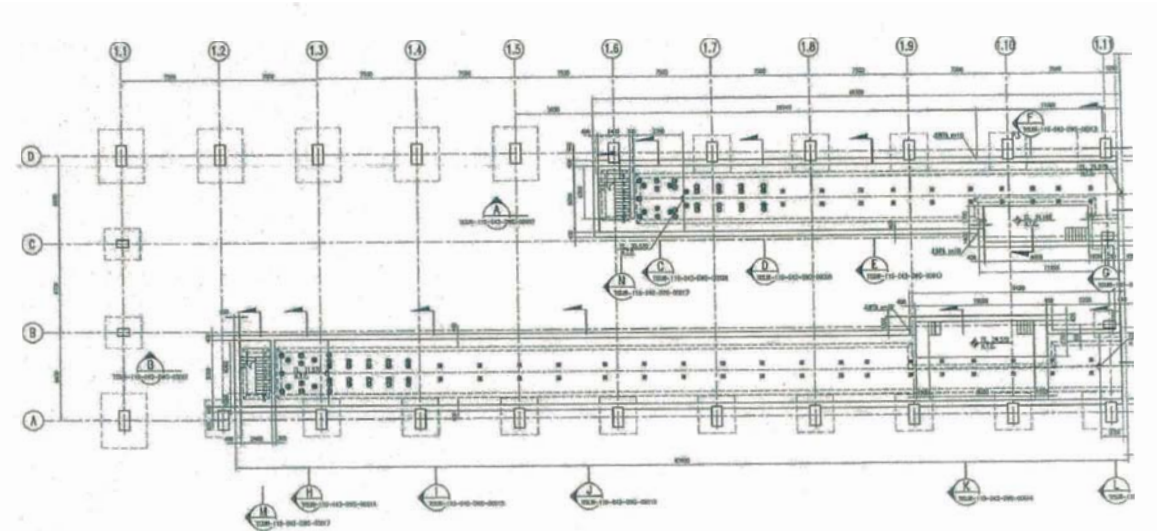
Planta de Fajas 1 y 5 (Fuente Proyecto Matarani)
